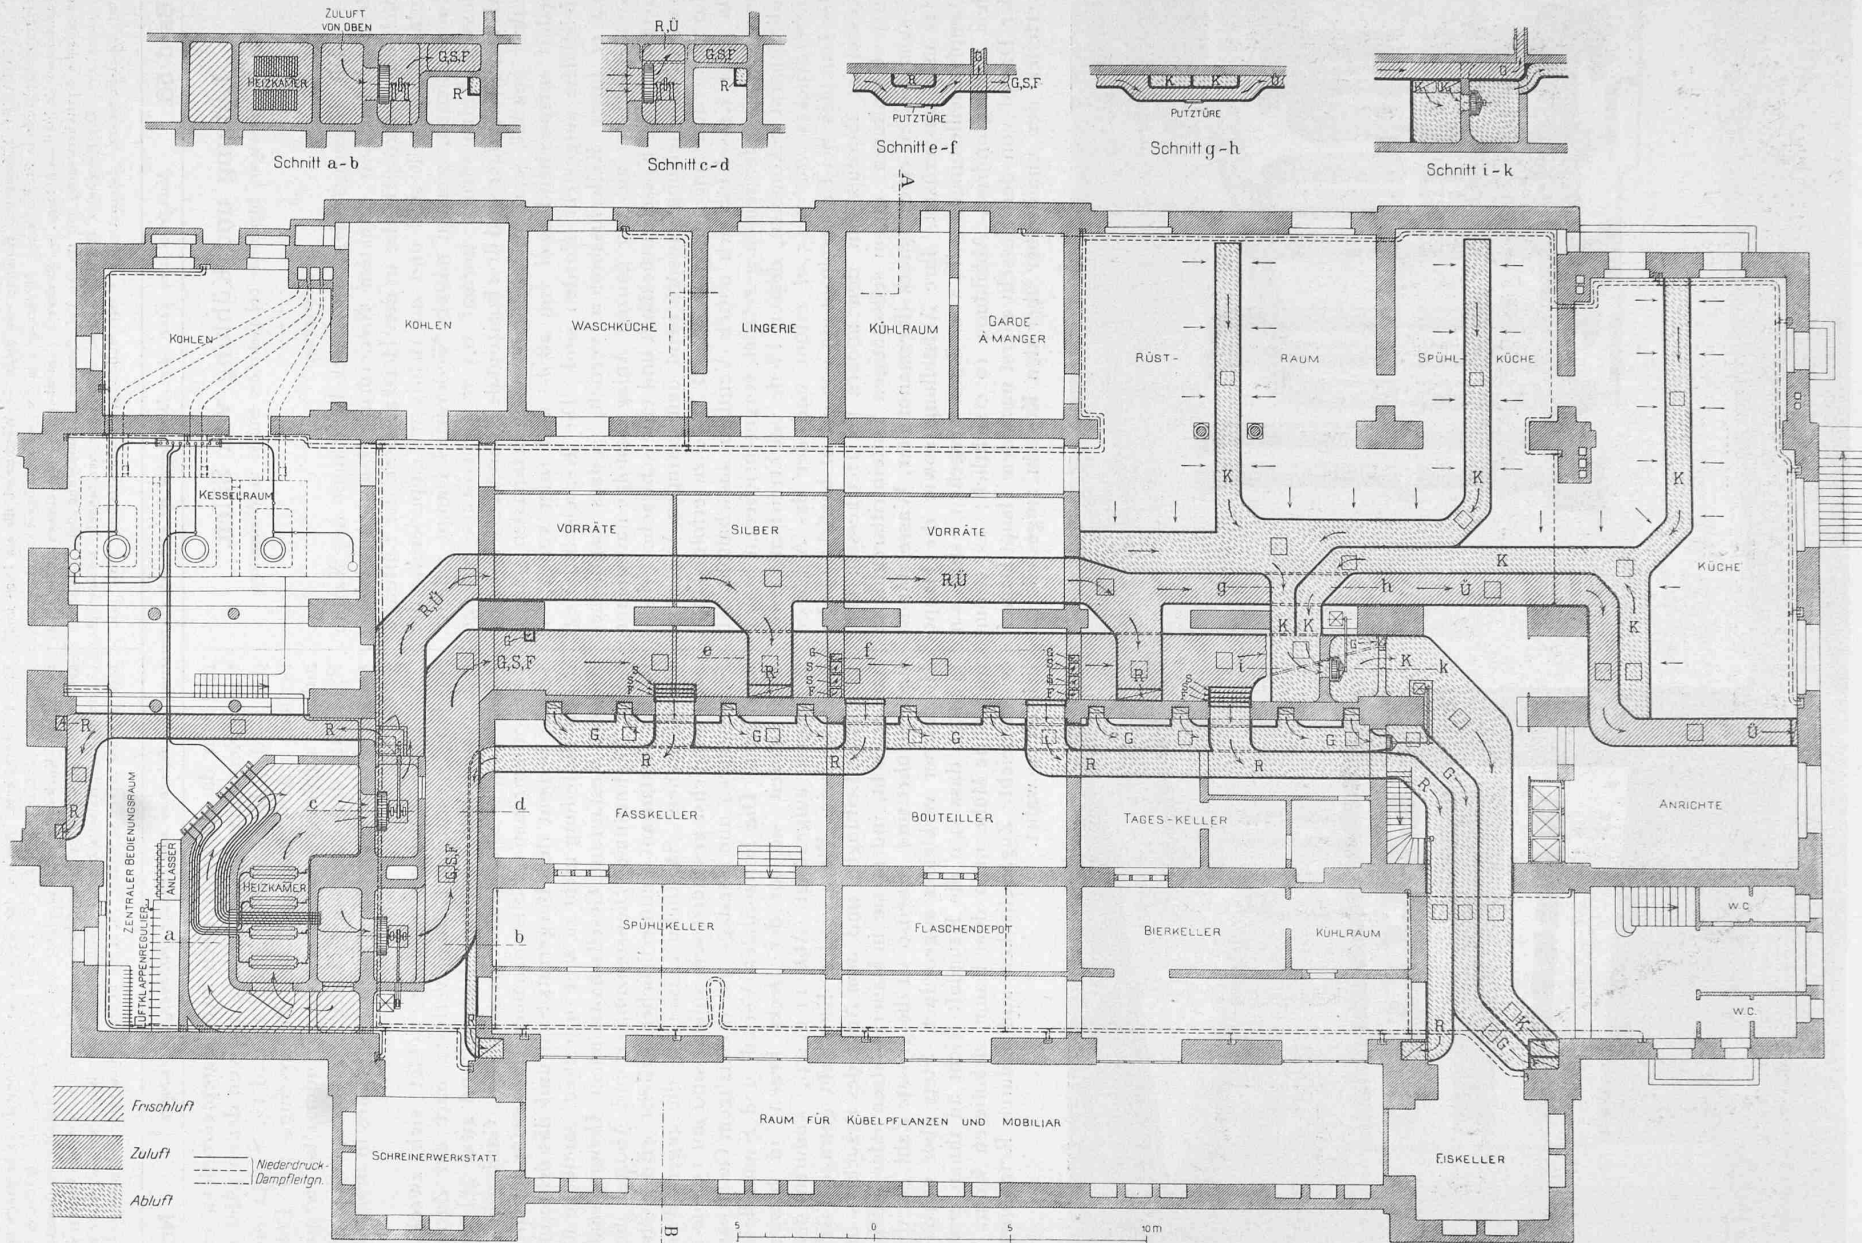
Grundriss des Kellergeschosses mit den an dessen Decke geführten Lüftungskanälen; Schnitte dazu. Legende siehe Seite 351. — Masstab 1:250.
